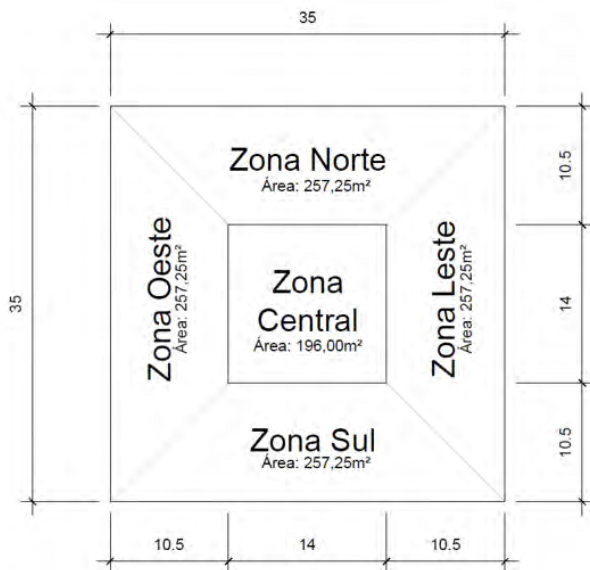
Planta Baixa esquemática do Pavimento Tipo e as Zonas
